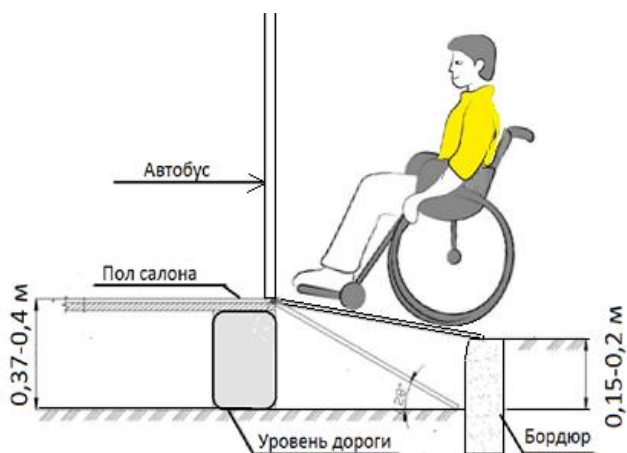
Безопасный уклон рампы автобуса обеспечивает повышенный уровень посадочной площадки
